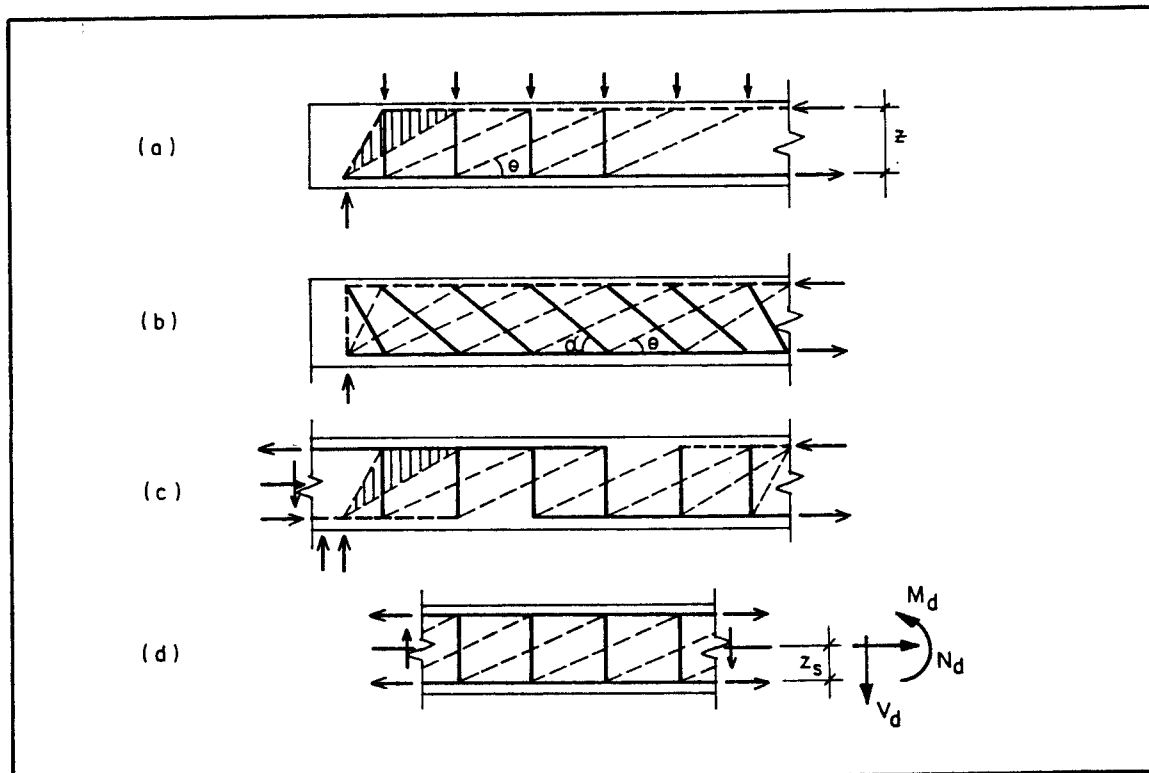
Modelos para vigas com banzos paralelos(Ref. 6)
